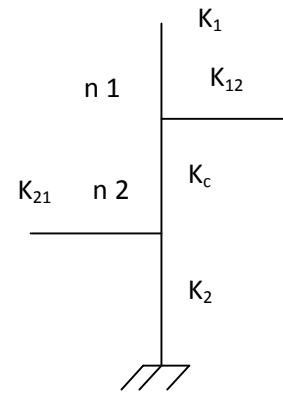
Rigidité des poutres et des poteaux sens Z-Z
